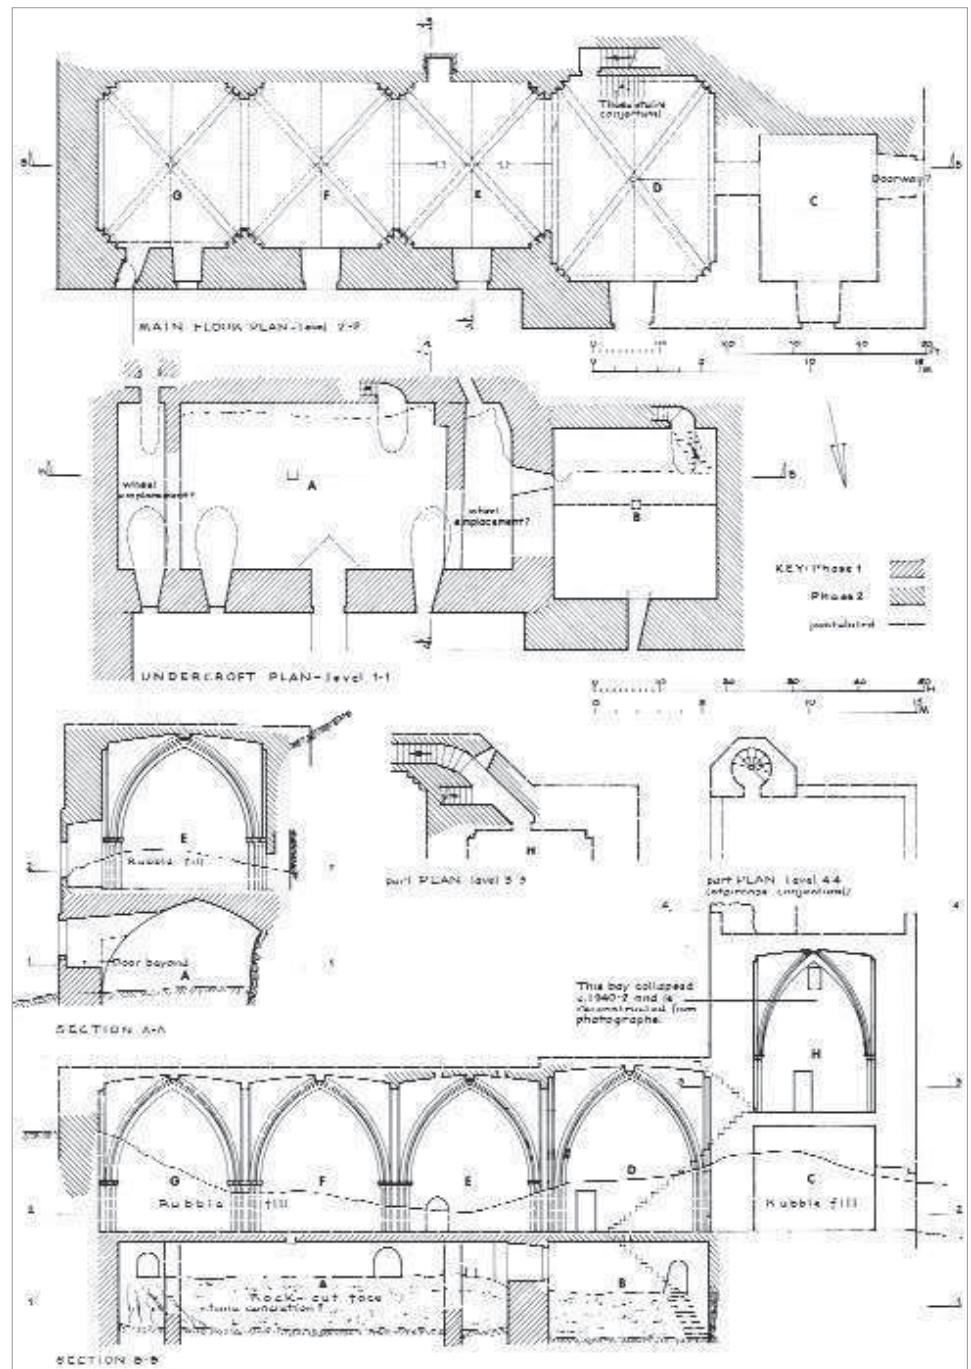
Mühlegebäude, Grundrisse und Schnittzeichnungen: oben Grundriss des Obergeschosses, darunter Grundriss des Untergeschosses, unten Längs- und Querschnitt
